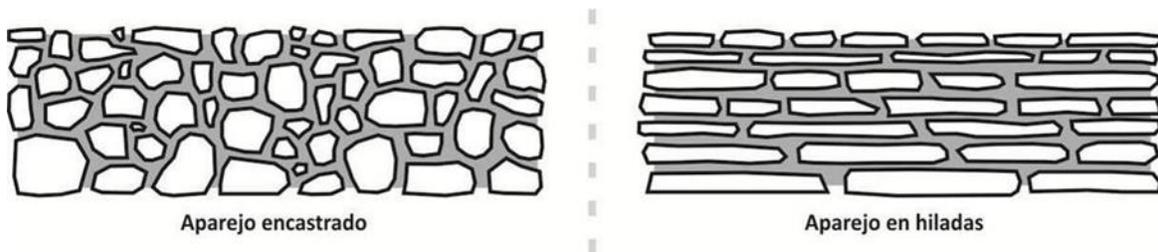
Esquema de los tipos de aparejos: en hiladas y encastrados.
